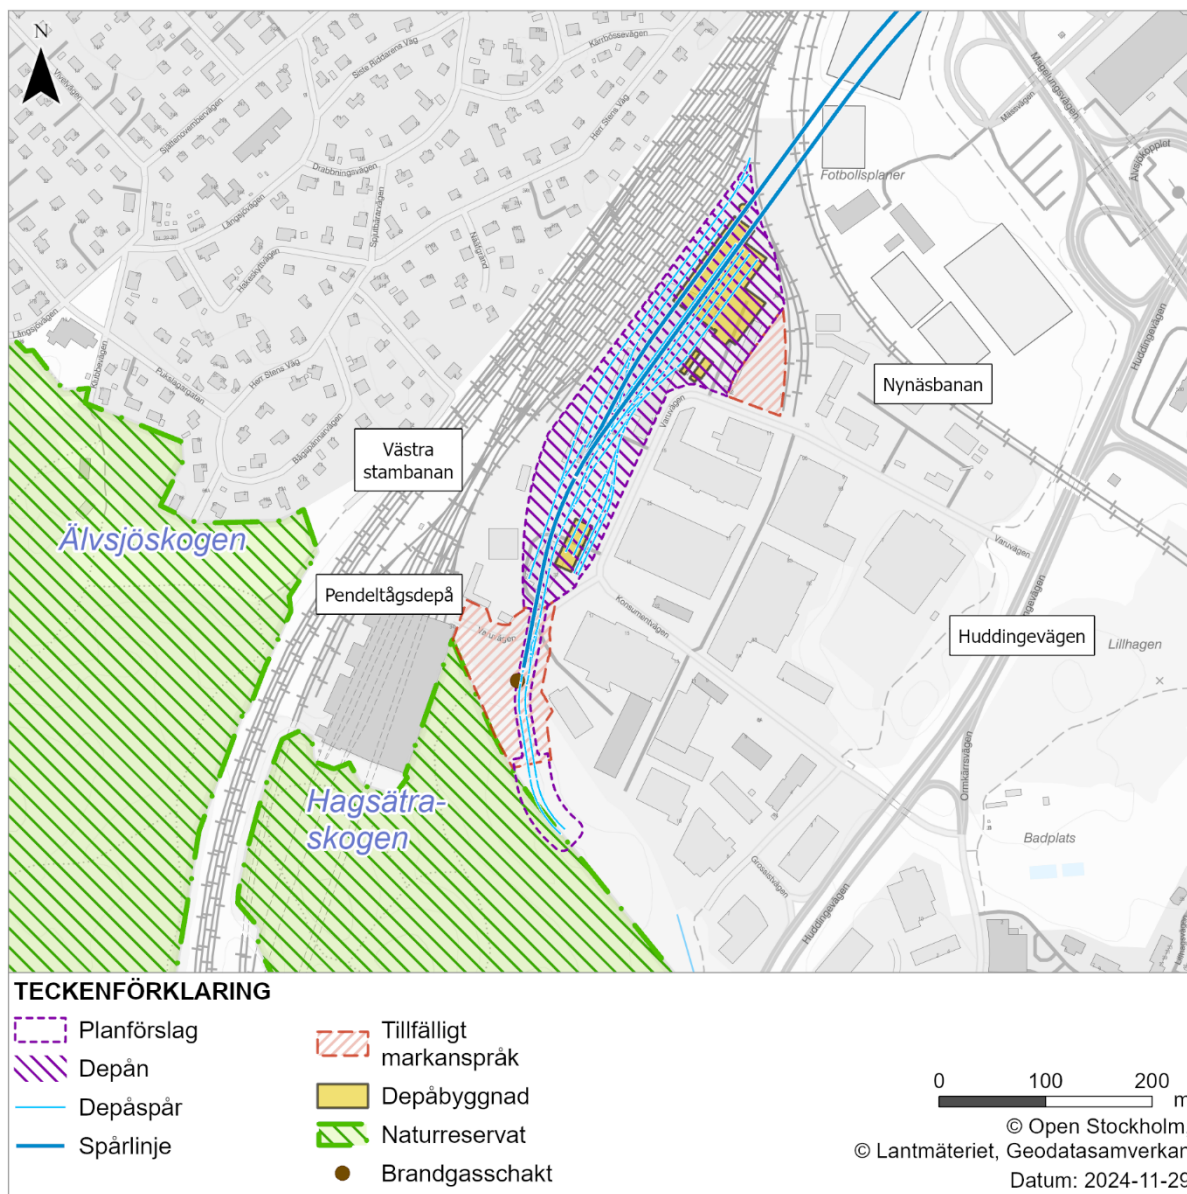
Situationsplan över planförslaget med planerade funktioner under och ovan mark.
